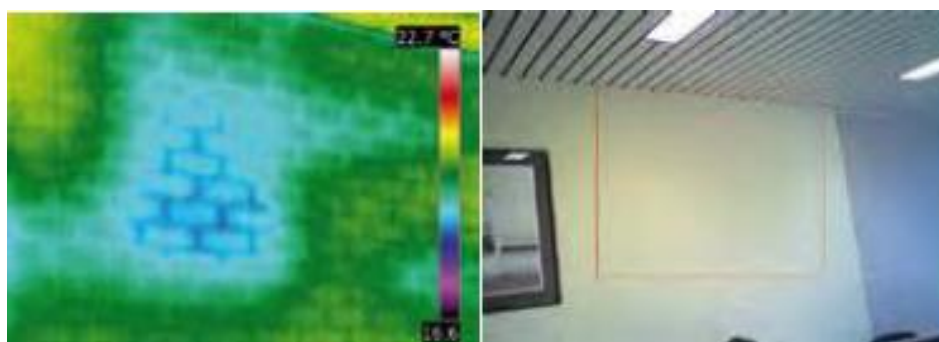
Termografia na deteção de falhas de isolamento em fachadas (FLIR 2010).
